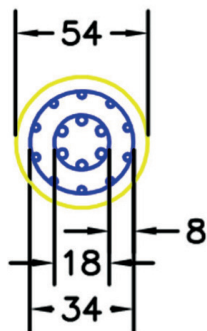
Detalhe das armaduras encontradas nos pilares.
